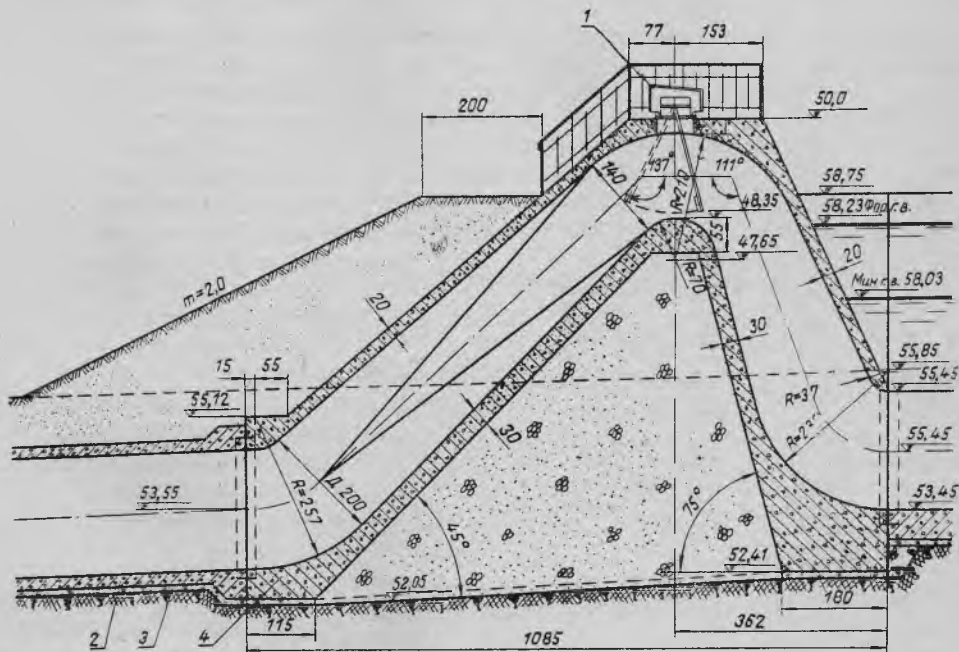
Железобетонный сифон, обеспечивающий укладку примыкающей части напорного трубопровода на материковый грунт (без подсыпки):
